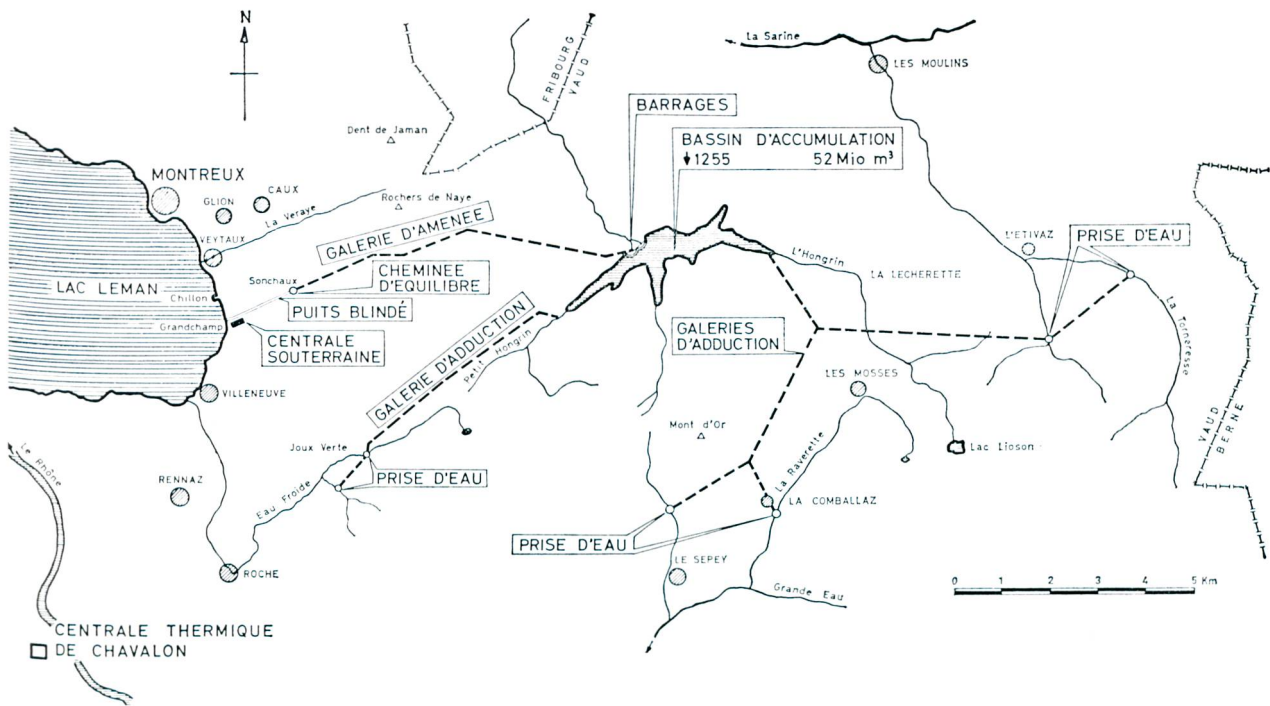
Lageplan der Wasserkraft- und Pumpspeicheranlage Hongrin-Léman.
